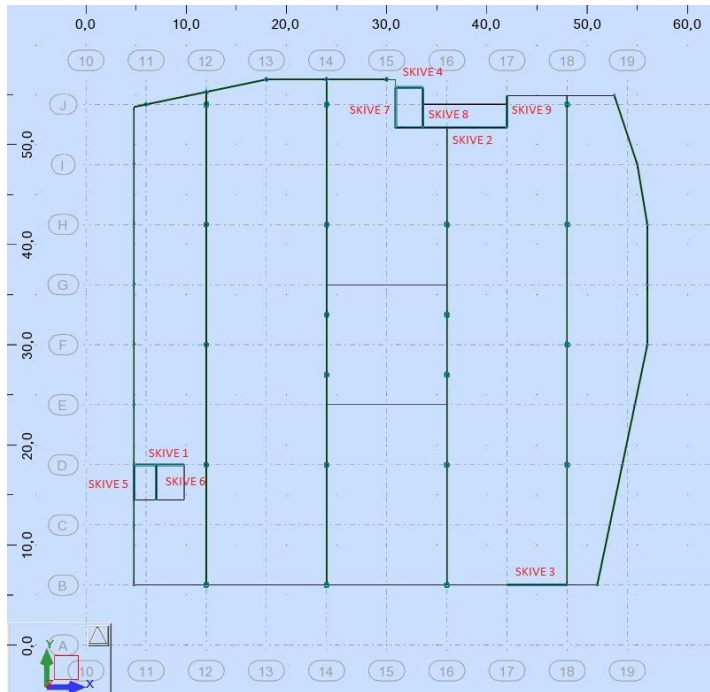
Plan 1 Kremmergården Kjøpesenter
